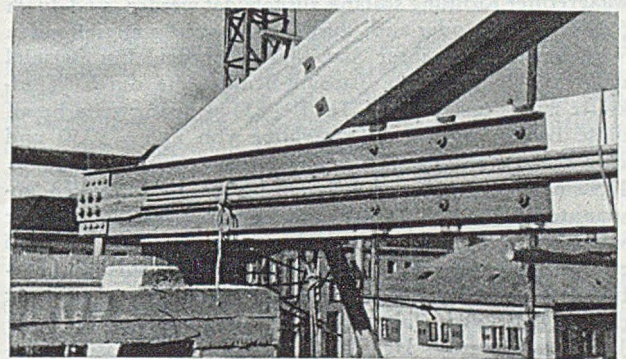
Auflager eines Hallenbinders mit Zugbandanschluss.
